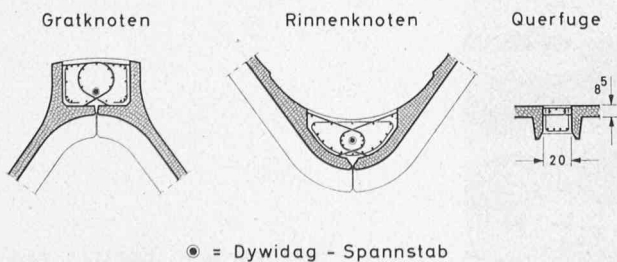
Paketumschlaghalle München, Verbindung der Fertigteile durch Ortbeton zum monolithisch wirkenden Bogentragwerk und Bewehrungsschema des Ortbetons
